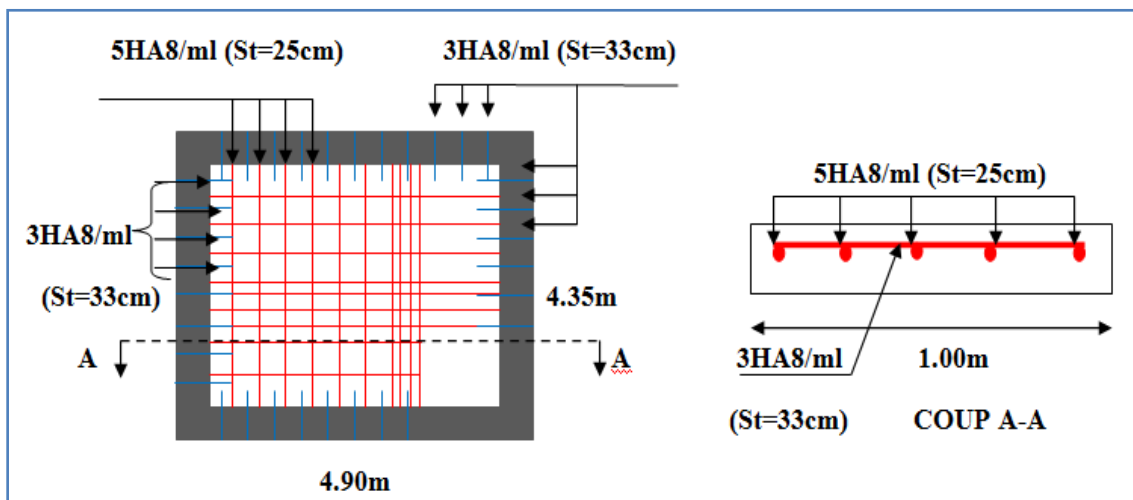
Schéma de ferrailage de la dalle sur quatre appuis.
